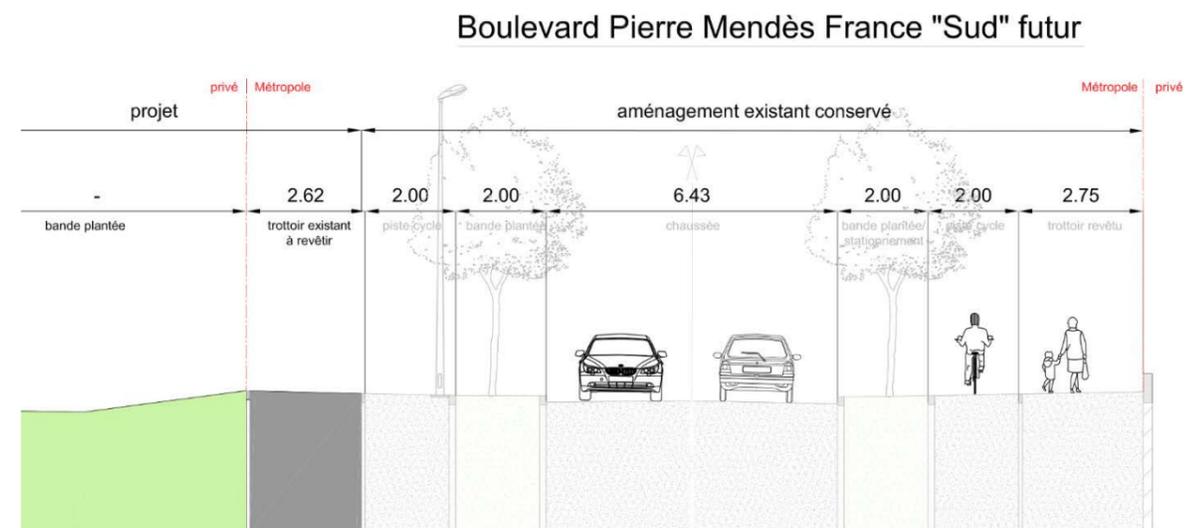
Projet – Boulevard Pierre Mendès France – section sud – coupe D
